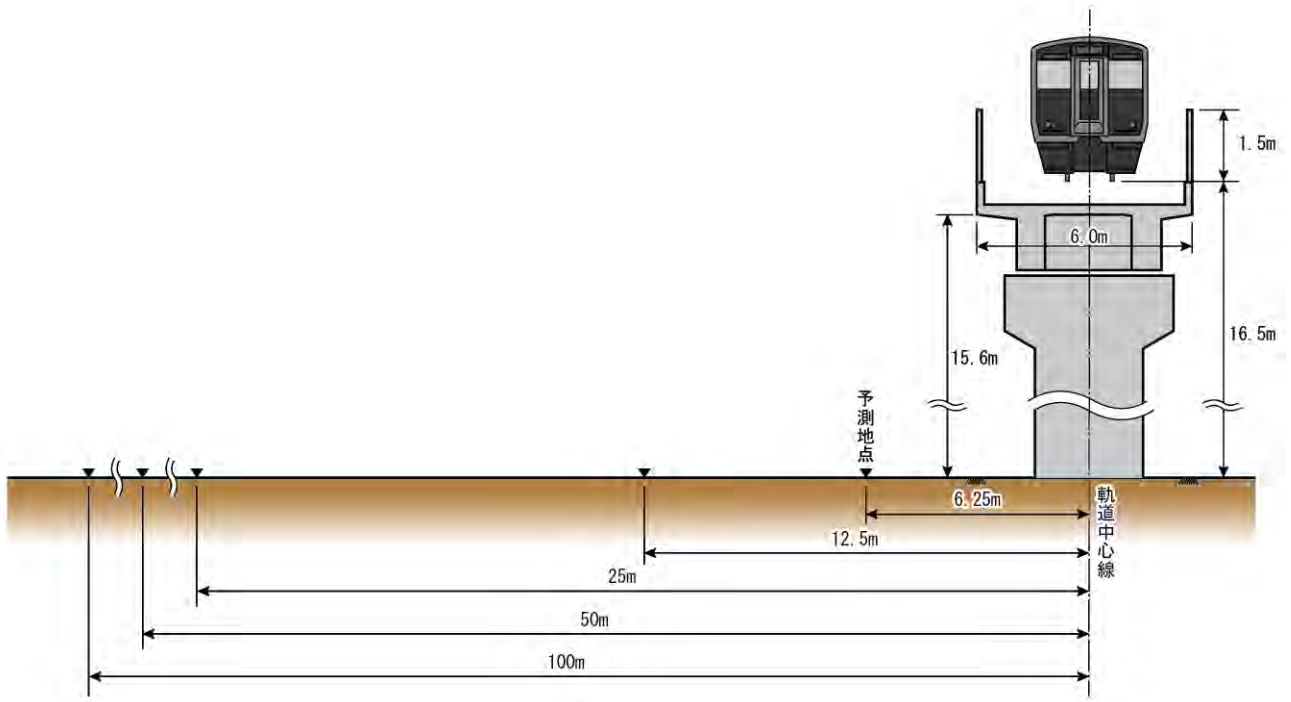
(4) 鉄道振動の予測断面図 (V-4)
